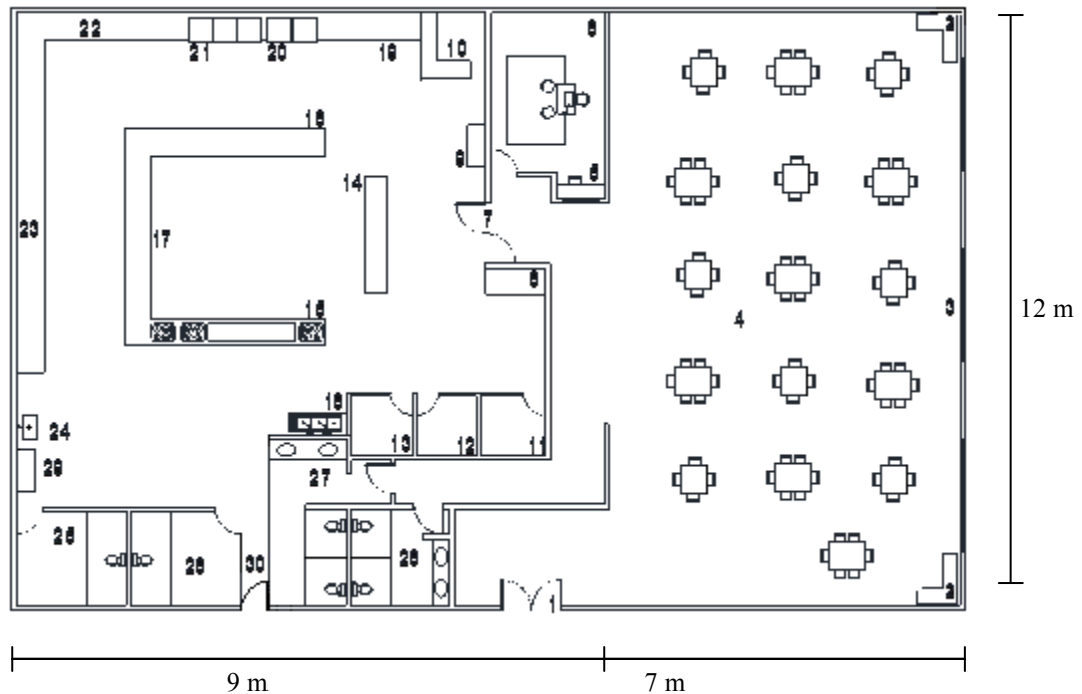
Plano arquitectónico de Restaurante Mezcal
